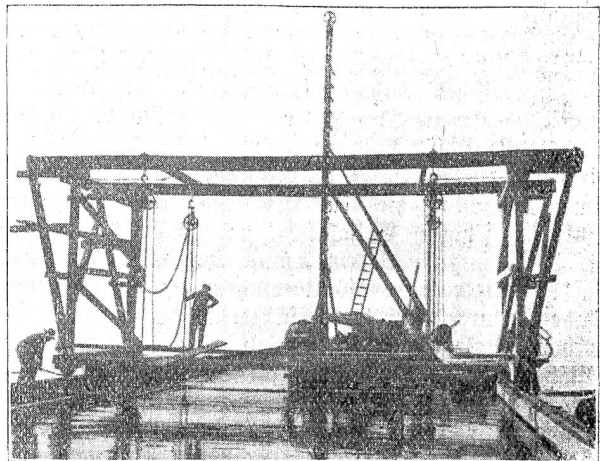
Absenkung, Betonelement unter dem Seespiegel.
